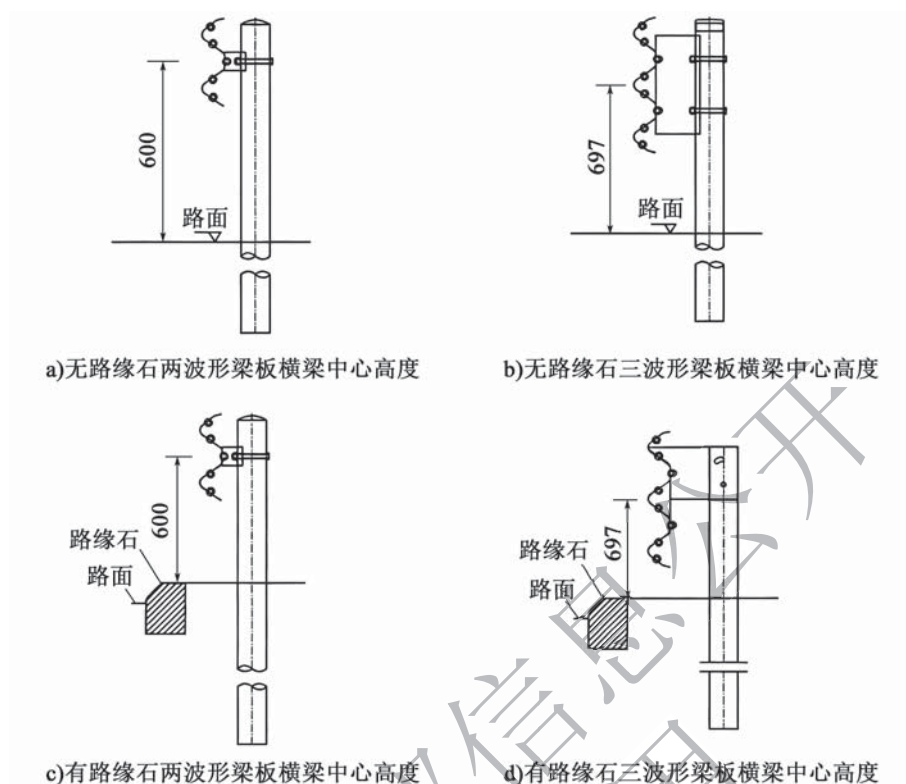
横梁中心高度示意图 (尺寸单位: mm)
